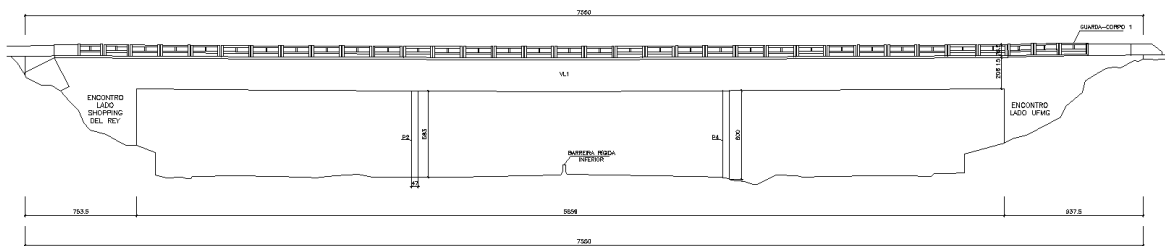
Vista longitudinal de um dos lados da estrutura (acervo do autor)
